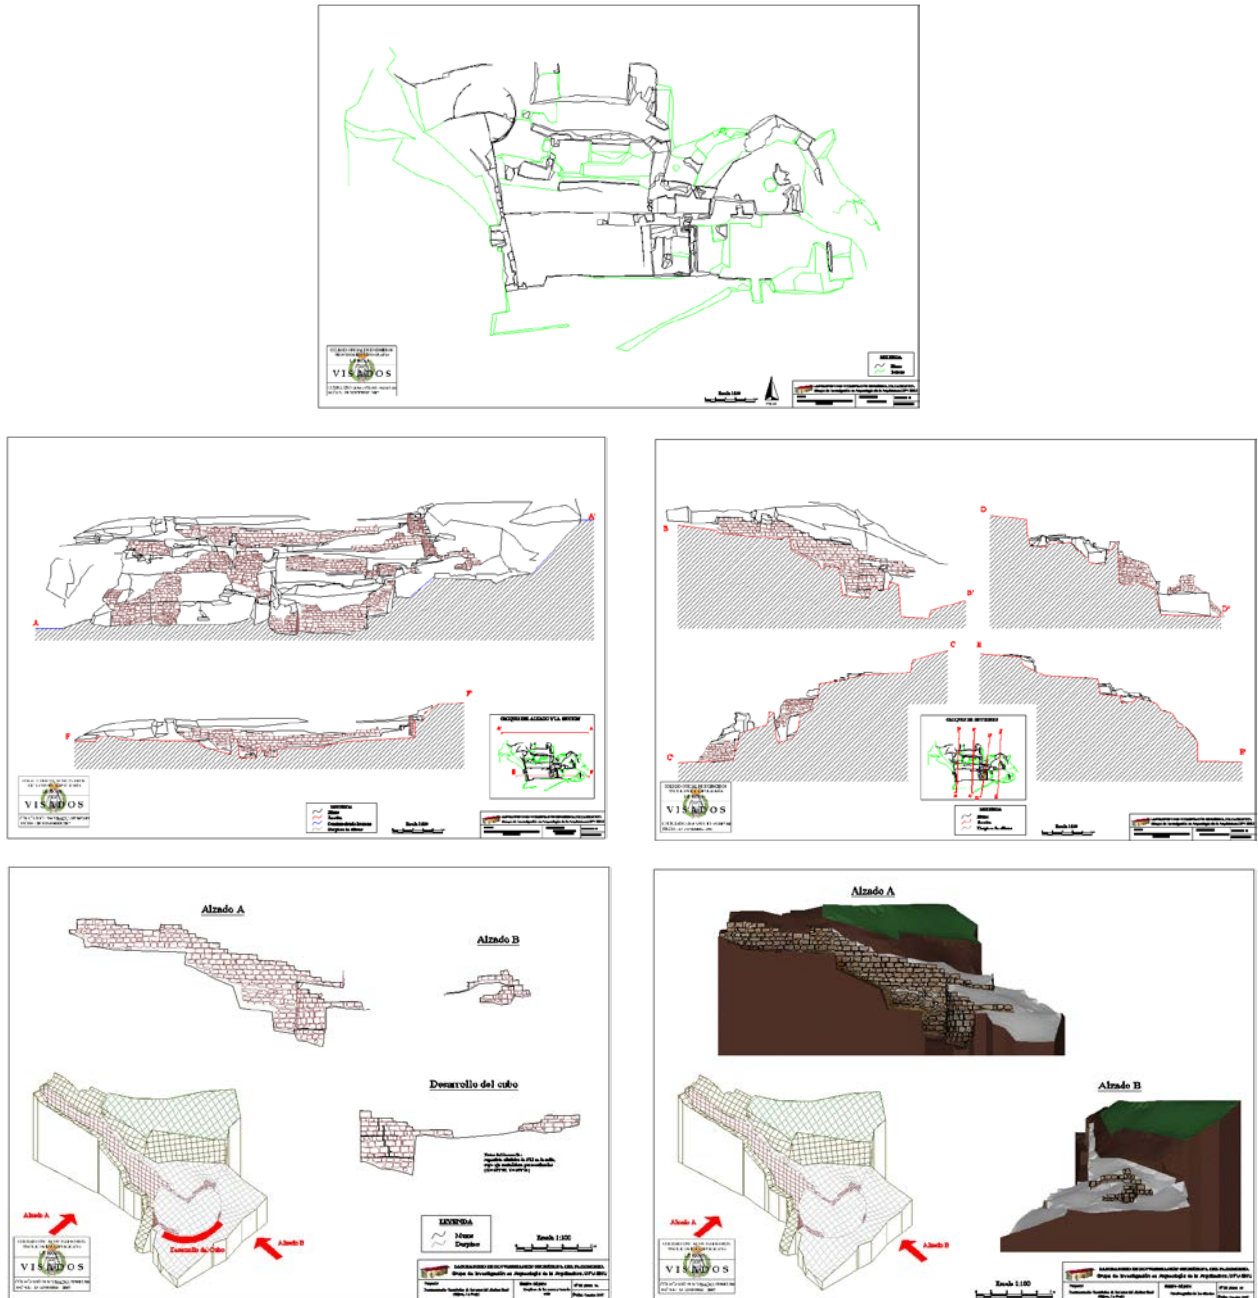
Salidas gráficas, arriba, vista en planta, zona central, secciones y alzado, zona inferior, despiece del muro oeste y cubo circular.
